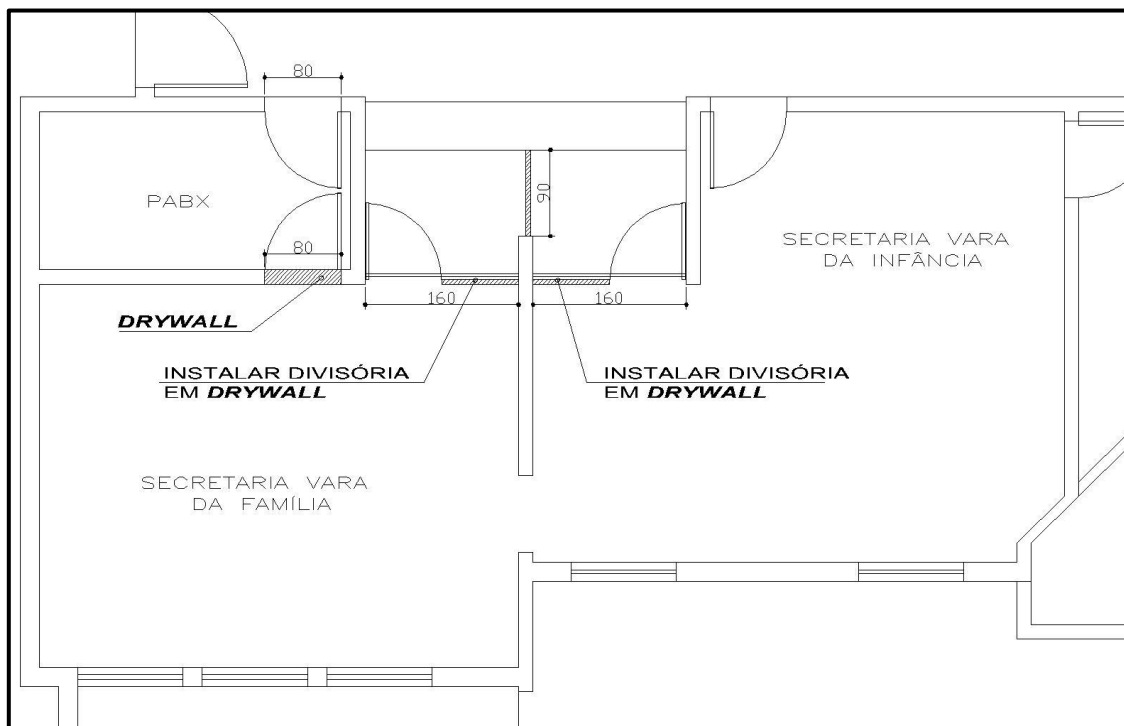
As *hachuras* representam as paredes construídas em *drywall*.
